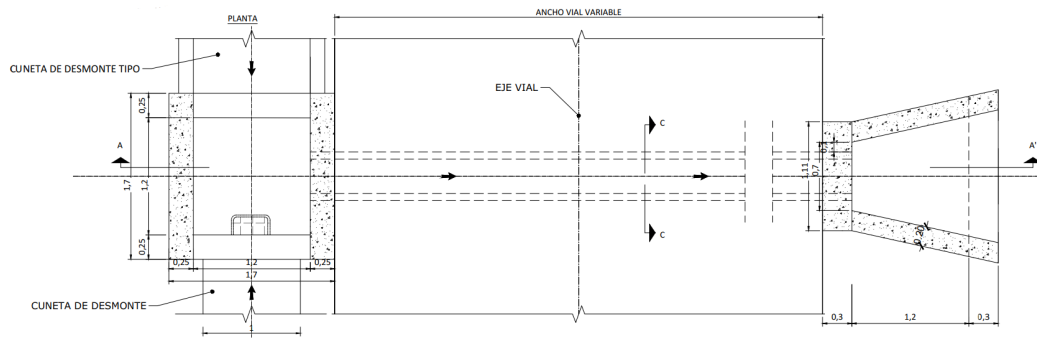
Detalle tipo 1 – (Planta) Obra de drenaje transversal (ODTL) arqueta-boquilla.
